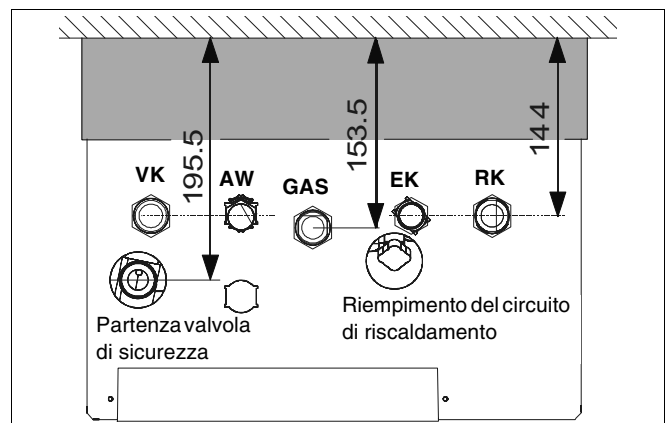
Pianta della posizione dei collegamenti (misure in mm)
